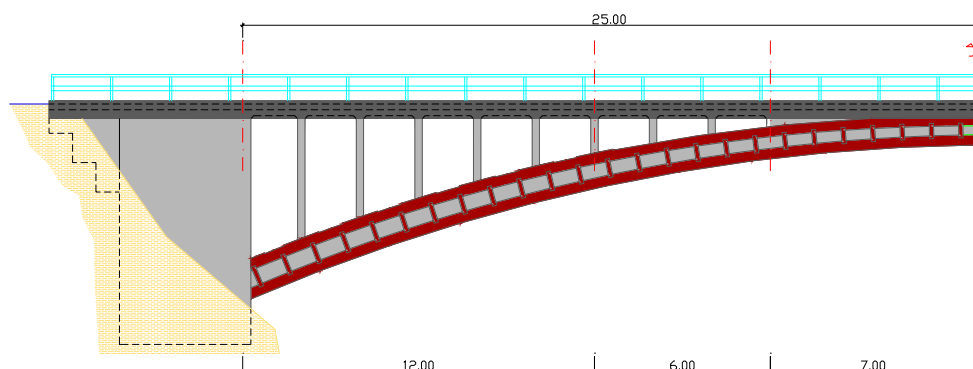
Alzado de solución de refuerzo del arco de hormigón.
